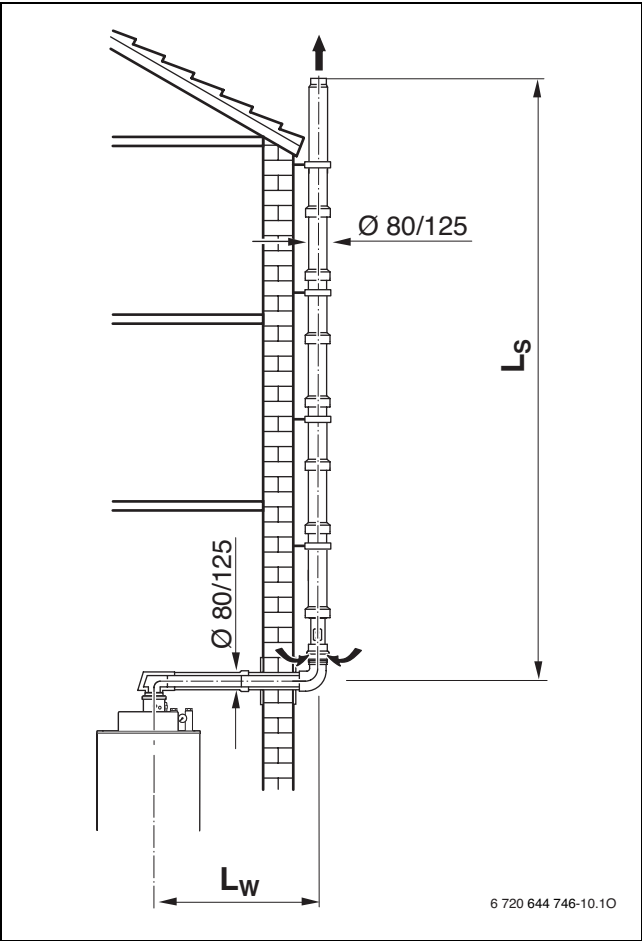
Doppelrohrführung an der Fassade (C_{53(x)})
